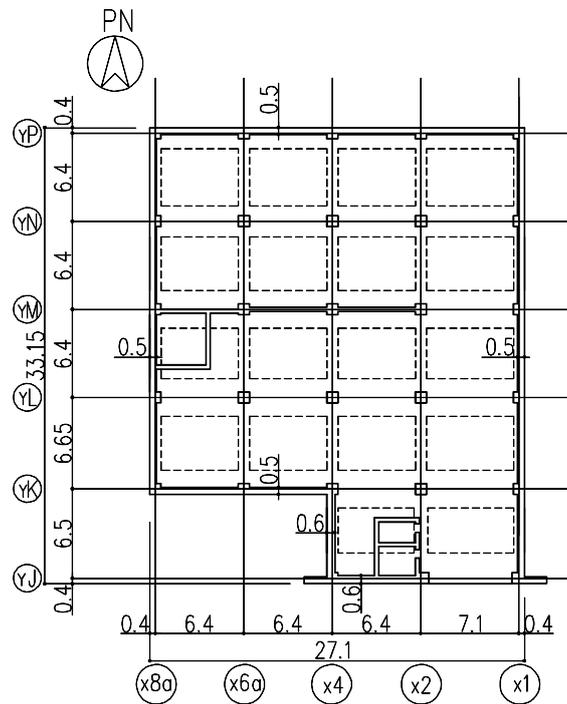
地下2階平面図 (G.L. -8.7) (単位 : m)
